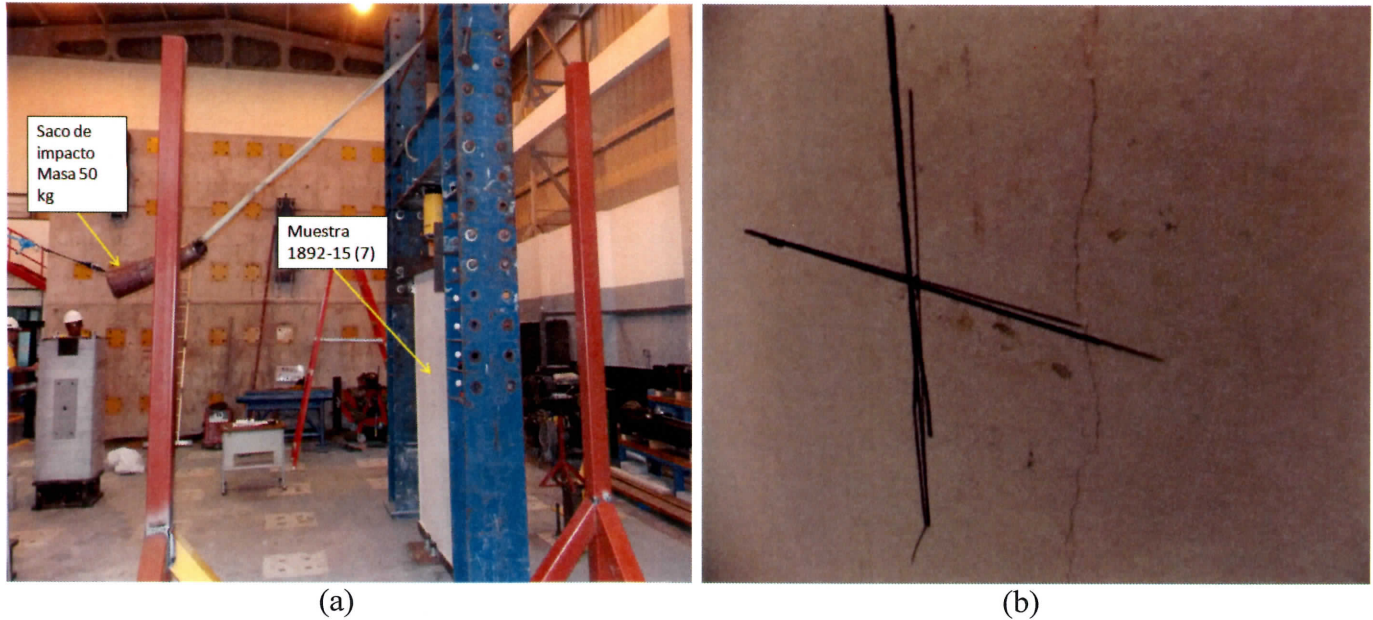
Ensayo de impacto en muros muestra 1892-15 (7): a) montaje del ensayo, b) detalle de daños, fisura de aproximadamente 2 m de longitud.
